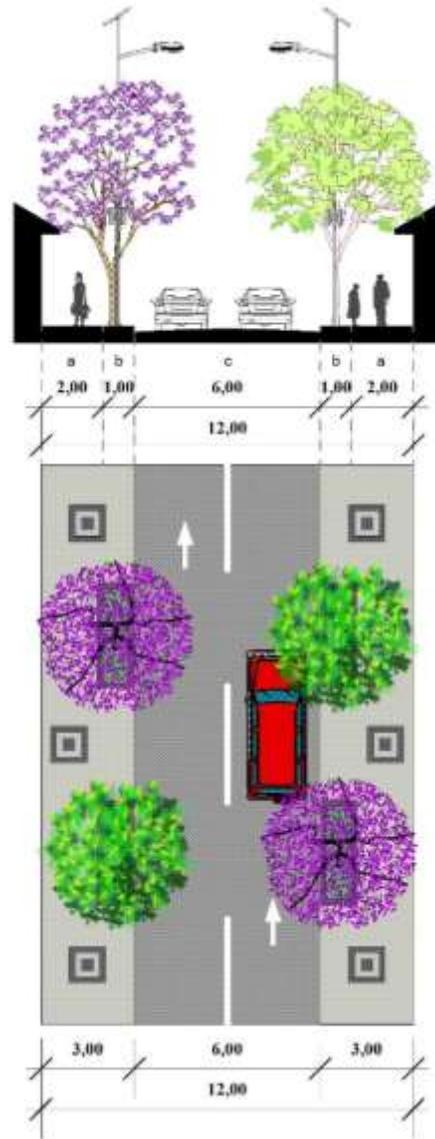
perfil propuesto de vía estructurante de tránsito vehicular – Z 1,2 y 3
